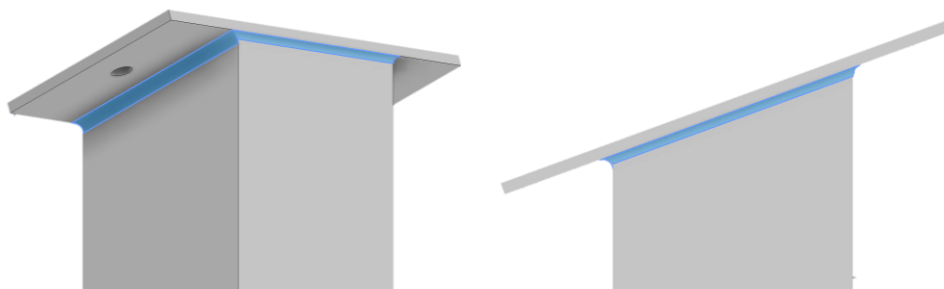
35 Soldadura de Columna - Placa de sujeción Viga
